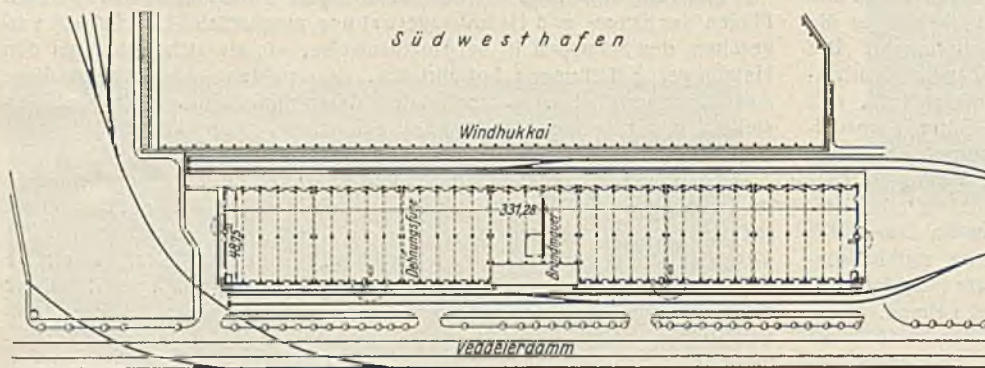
Grundriß des Kaischuppens in Eisenbeton-Schalbauweise.
